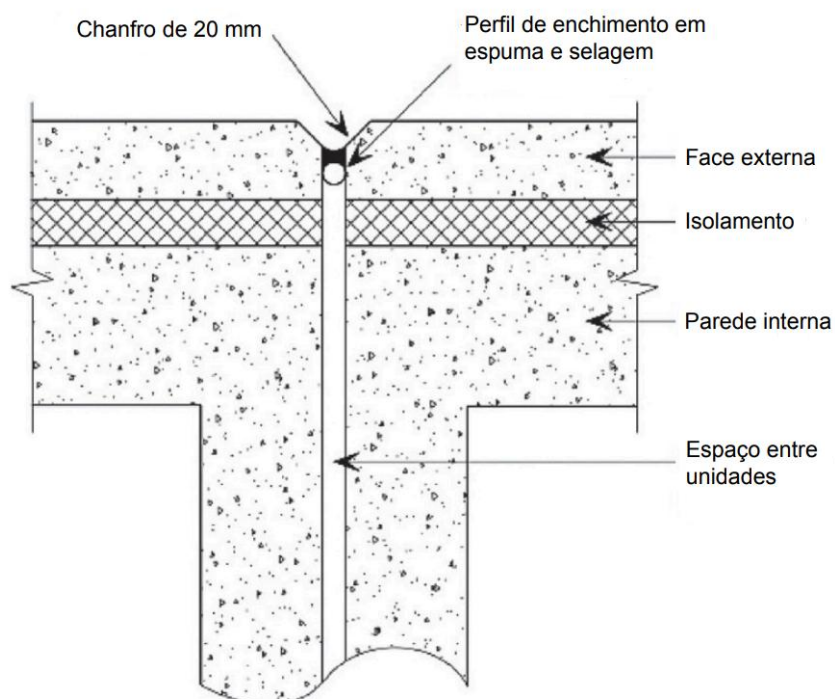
Ligação exterior entre módulos pré-fabricados em planta com isolamento e vedação [20].
